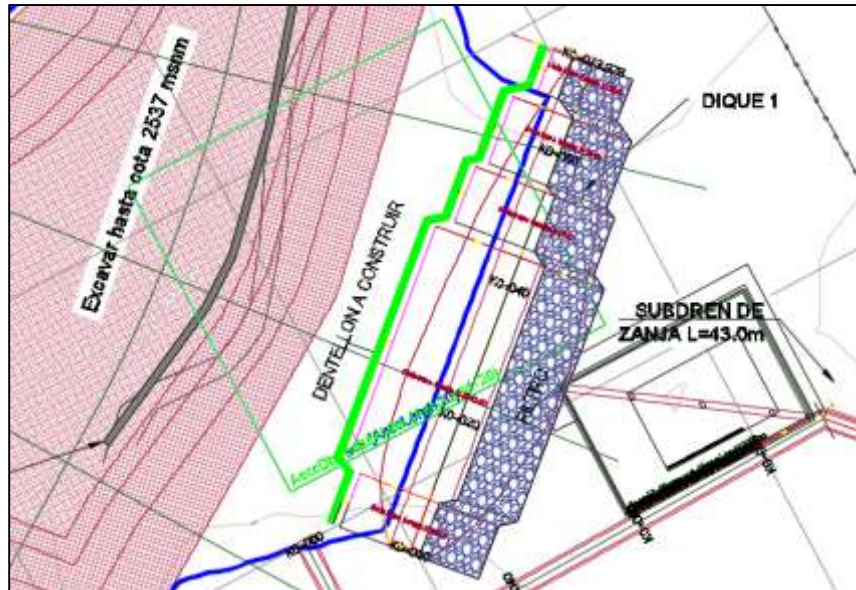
Dibujo en planta Dique 1 - Embalse Málaga
